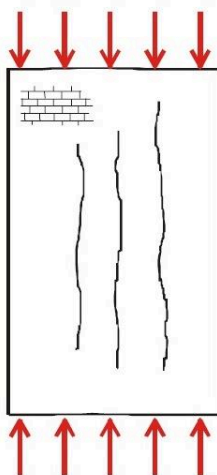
Fissuras Verticais induzidas por sobrecargas (DUARTE, 1998).
